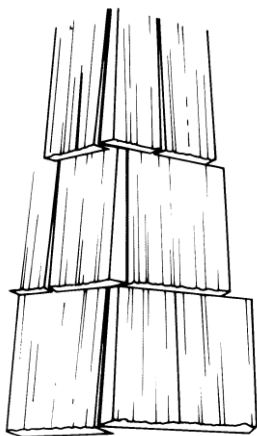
Углы гонта и дранки могут быть переплетены или перекрыты
